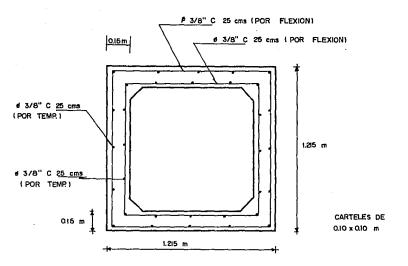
DISEÑO DE LA SECCION DEL DUCTO DE LA OBRA DE TOMA.
